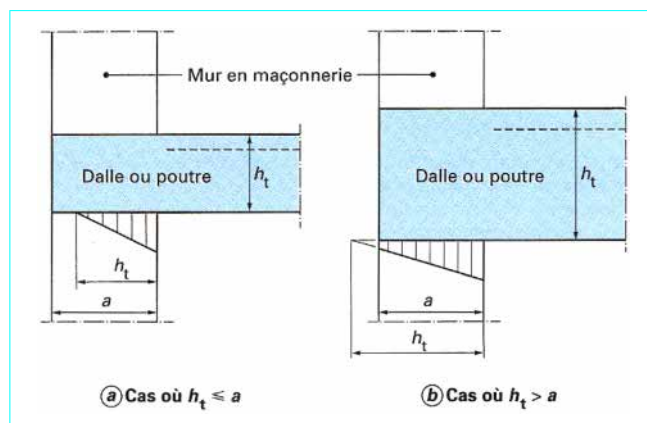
Dalle ou poutre perpendiculaire au plan moyen du mur : répartition des contraintes
